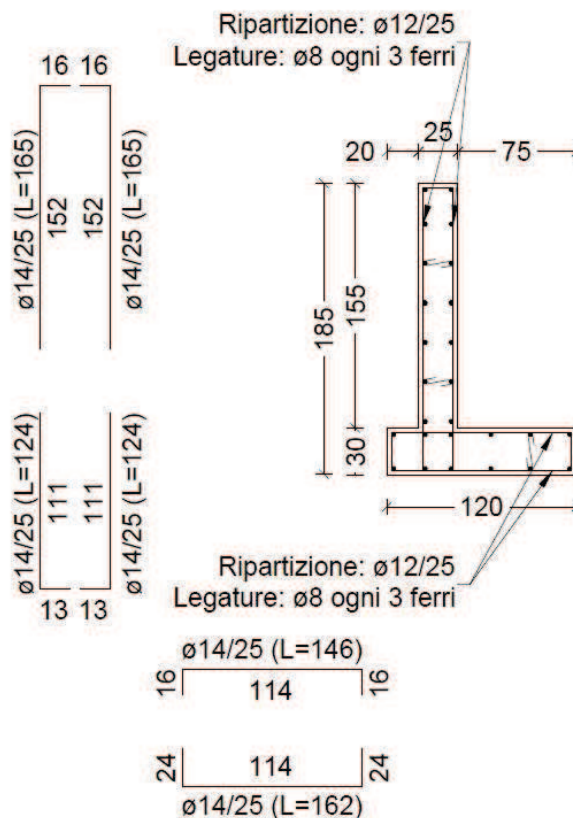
INTERVENTO 2 - Dettaglio del muro di contenimento a protezione della strada
